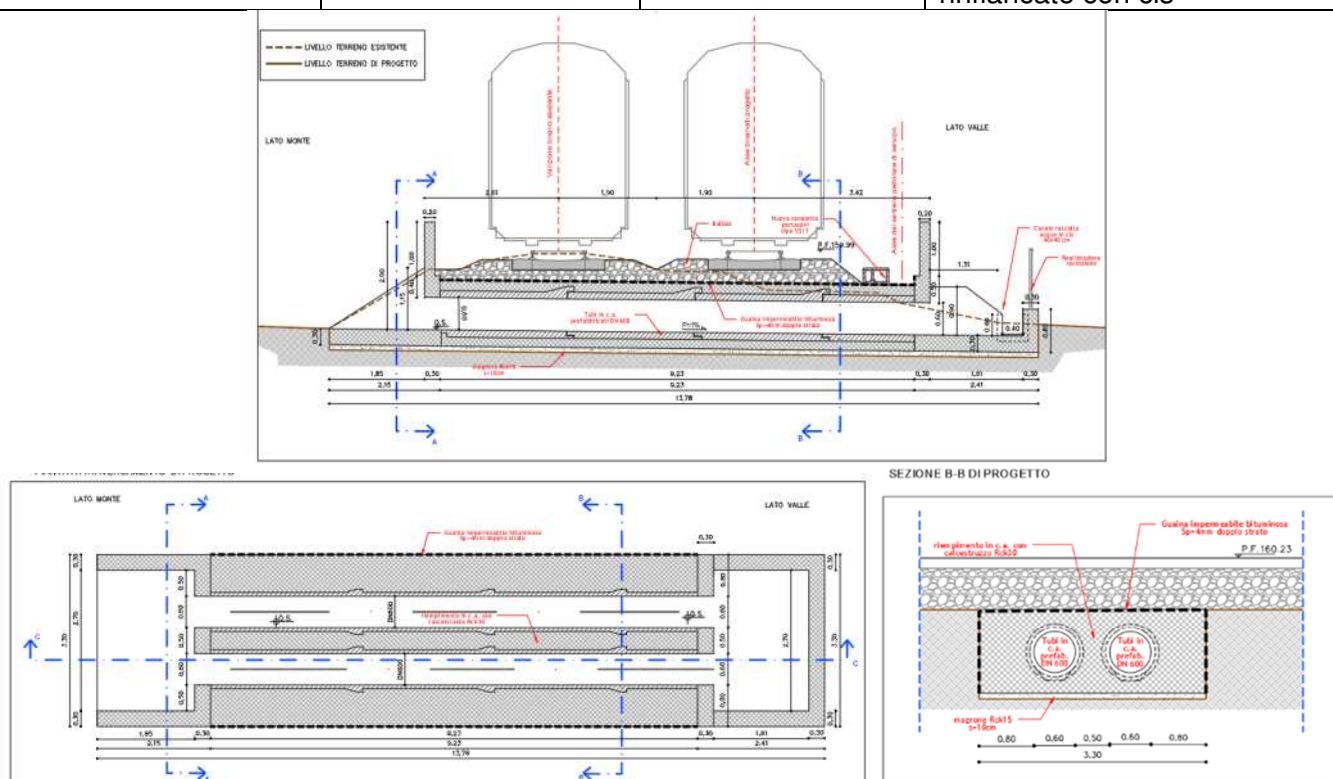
Pianta, Sezione e Profilo longitudinale tombino km 18+459,00
